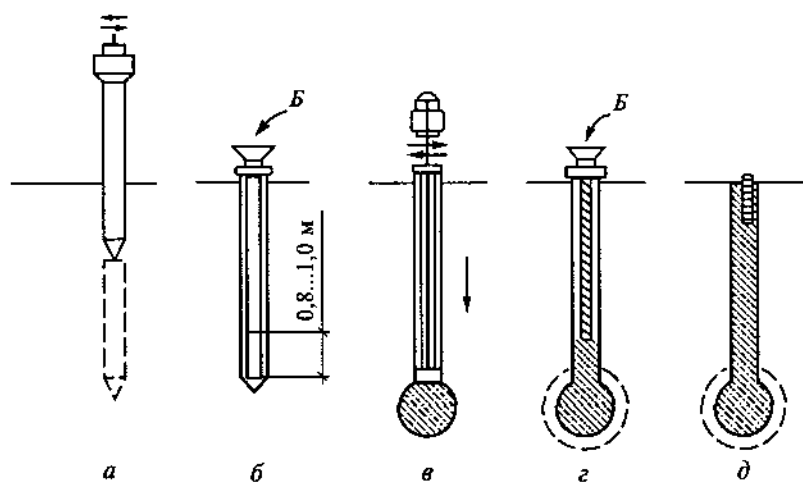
Технологическая схема устройства вибротрамбованных свай: а — устройство скважины; б, г — укладка бетонной смеси; в — уплотнение бетонной смеси; д — окончание бетонирования
